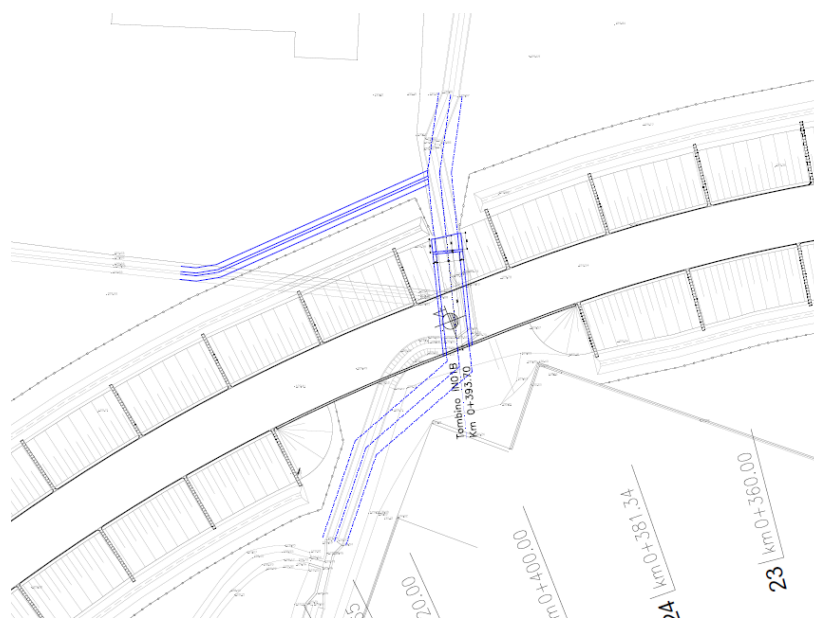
Stralcio planimetrico IN01b – Opere di progetto in blu
